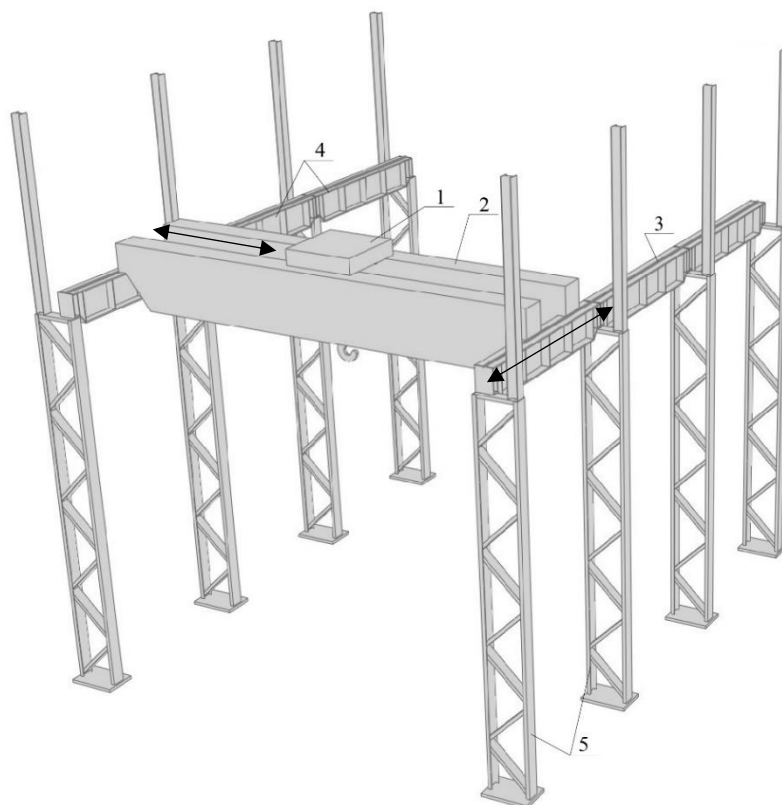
Схема расположения несущих элементов конструкции подъемно-транспортных машин: 1 – тележка крана; 2 – мостовой кран (кран-балка); 3 - крановые рельсы; 4 – подкрановая балка; 5 – колонны
